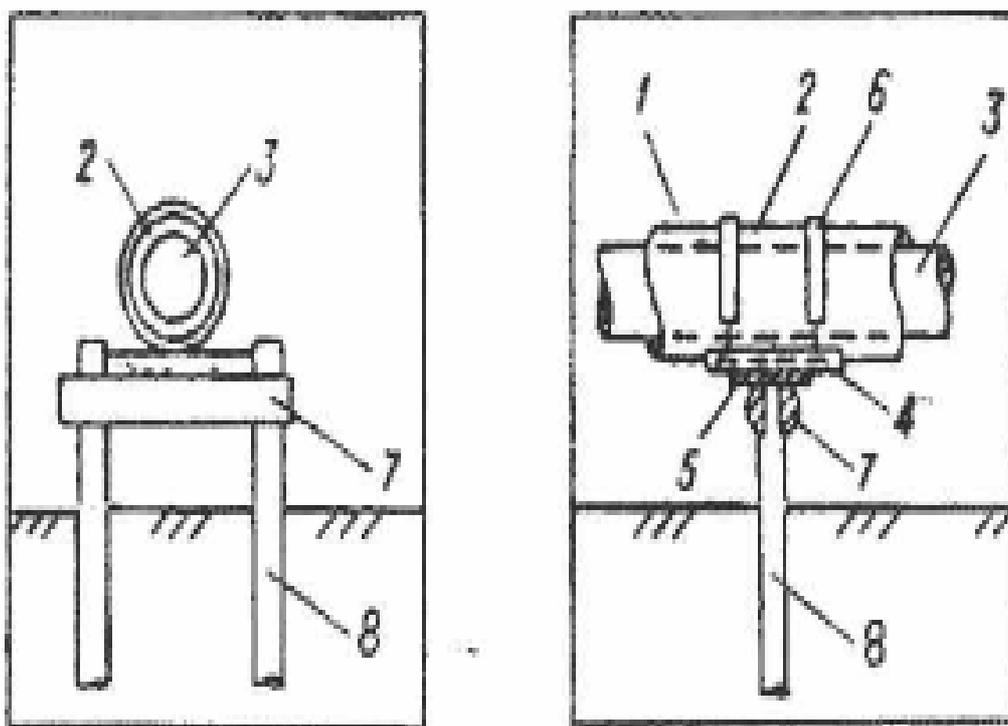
Двухсвайная опора теплоизолированного трубопровода:
